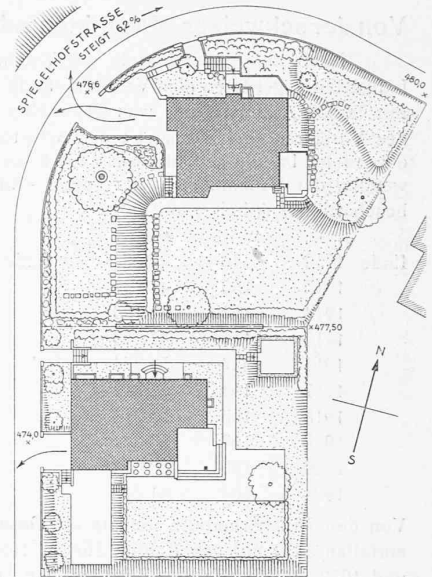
Lageplan 1 : 800 der Häuser Wegelin (oben) und Stiefel (unten).
